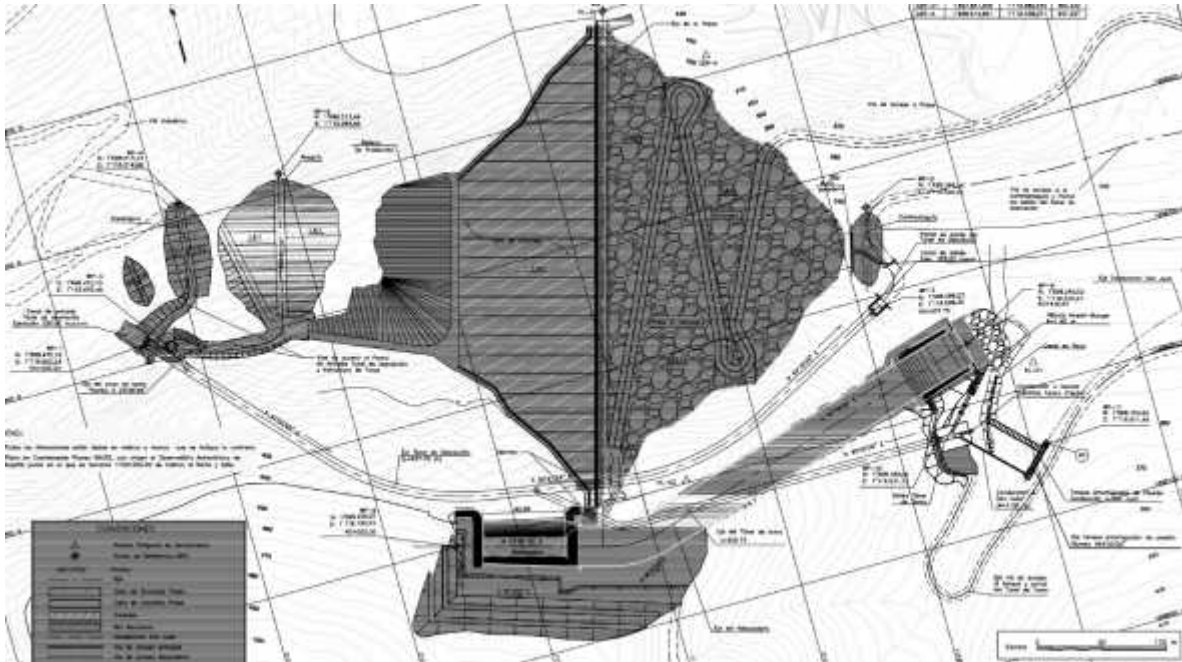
Diseño presa en planta (Fuente: ADR, 2020)
